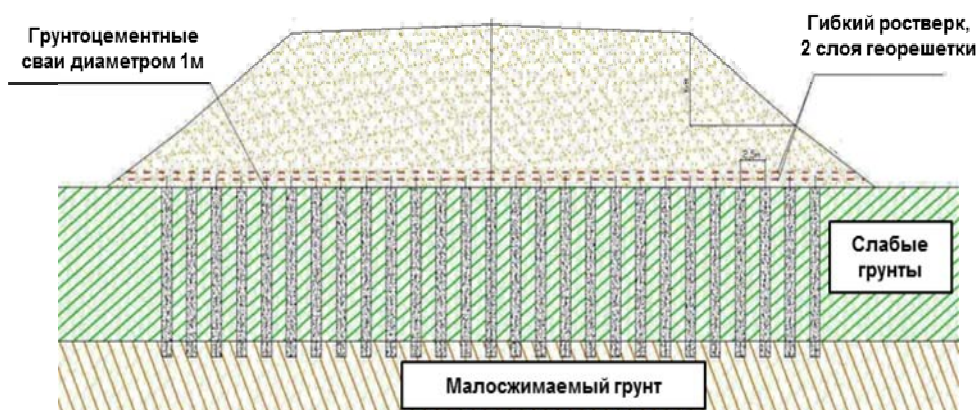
Схема конструкции насыпи на свайном основании с армогрунтовым ростверком
